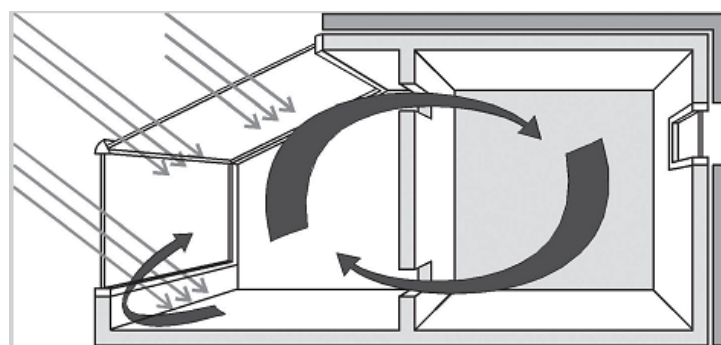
Sistema de Ganho Isolado – Estufa [7]
